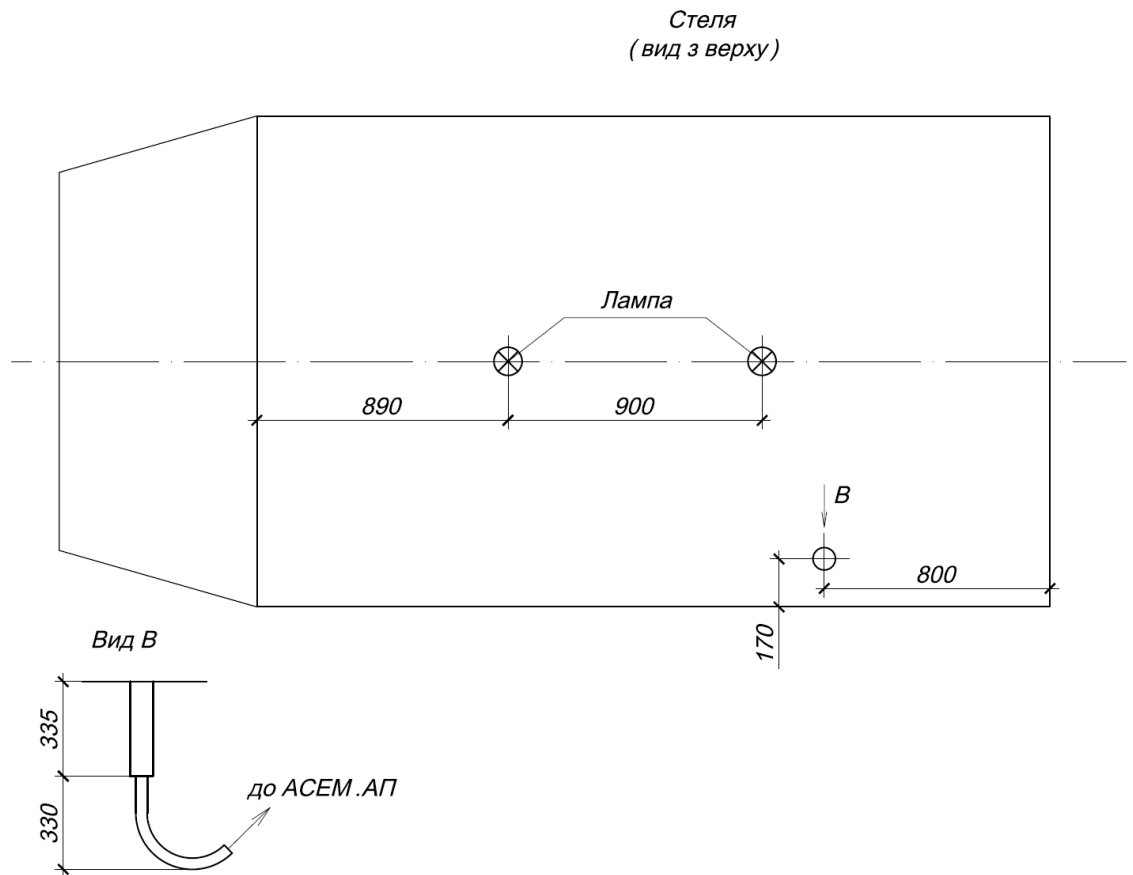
Ескізне креслення ПМЕЛ (Вид зверху та Вид В)
